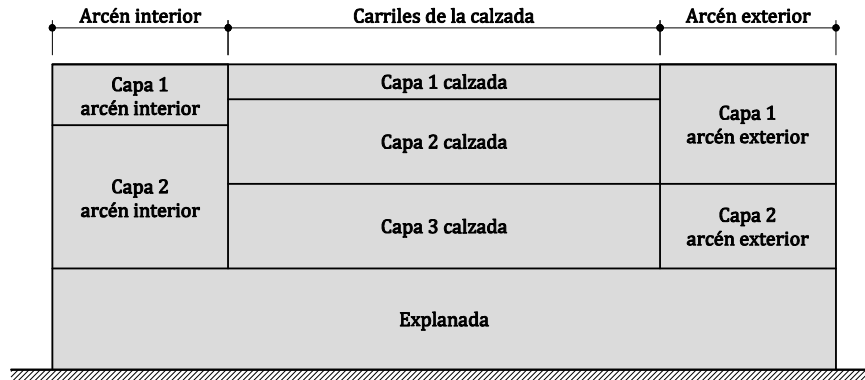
Ejemplo de sección transversal de un pavimento.
